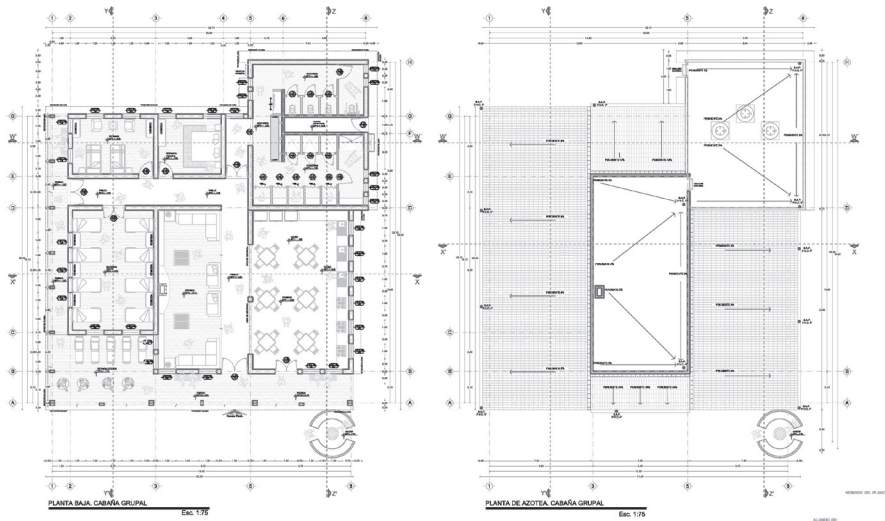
Planta de distribución de la cabaña tipo hostel y su planta de azoteas. Fuente: Tesis (Peralta & Vega, 2017)
